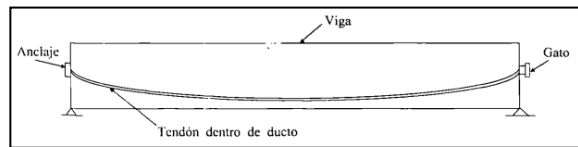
Esquema de distribución de cable de presfuerzo, en vigas postensadas
